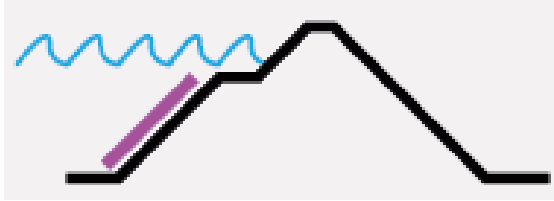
Schema constructieve oplossing dijkkern
